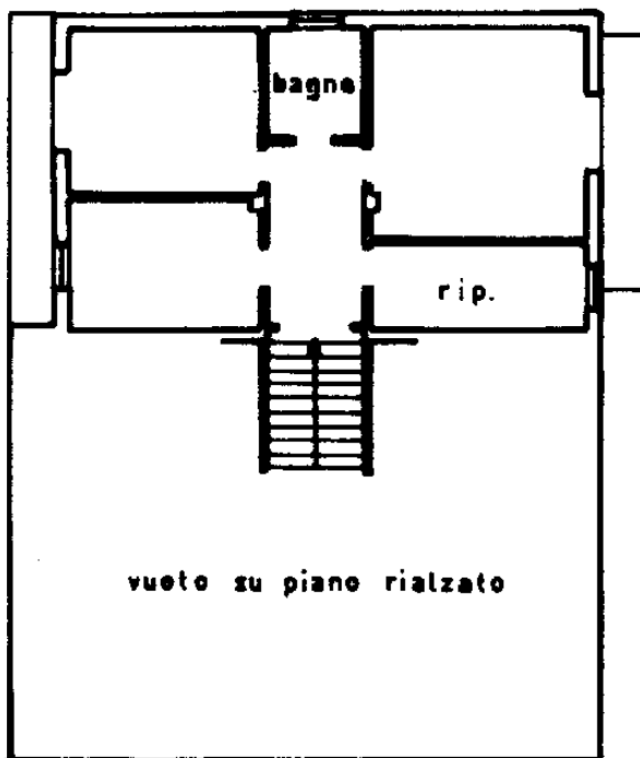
Planimetria catastali dei beni (sub. 6, p.1).
